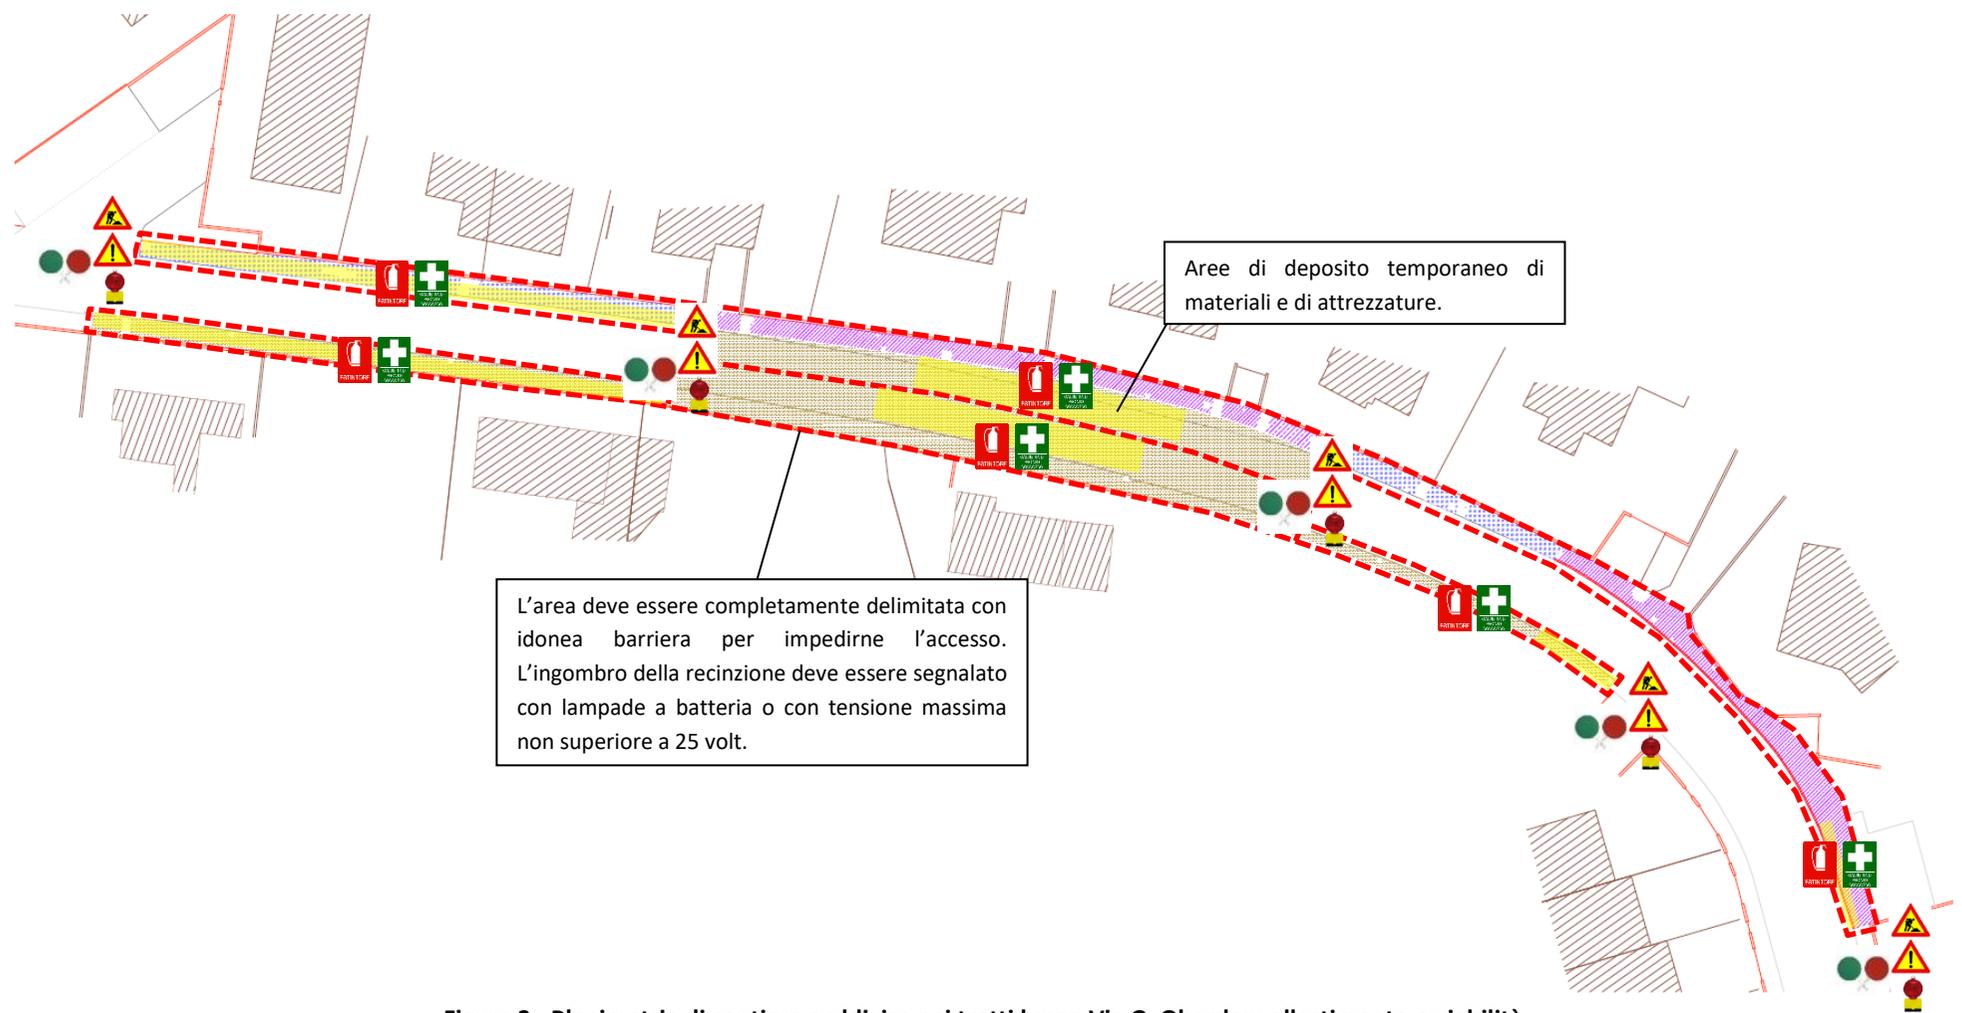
Planimetria di cantiere suddivisa nei tratti lungo Via G. Oberdan: allestimento e viabilità.
